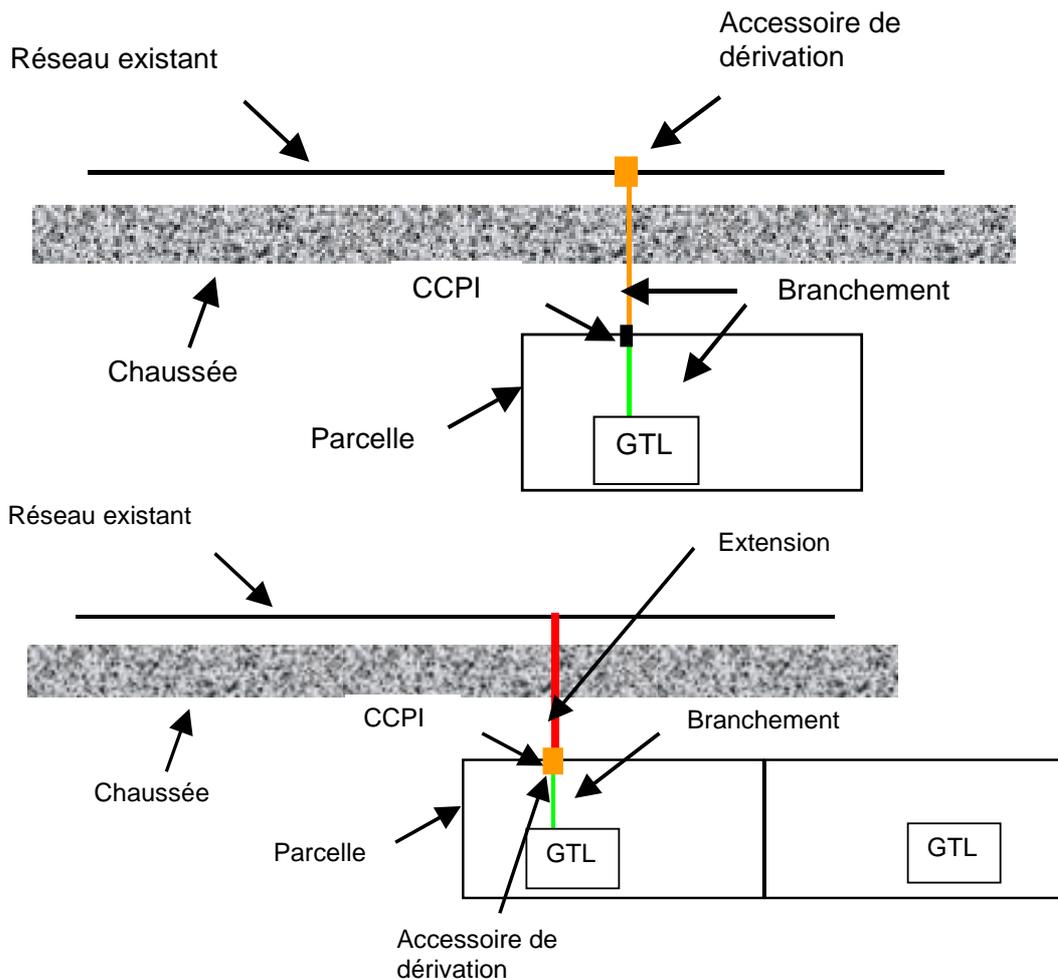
Raccordement individuel BT \leq 36 kVA avec traversée de chaussée
